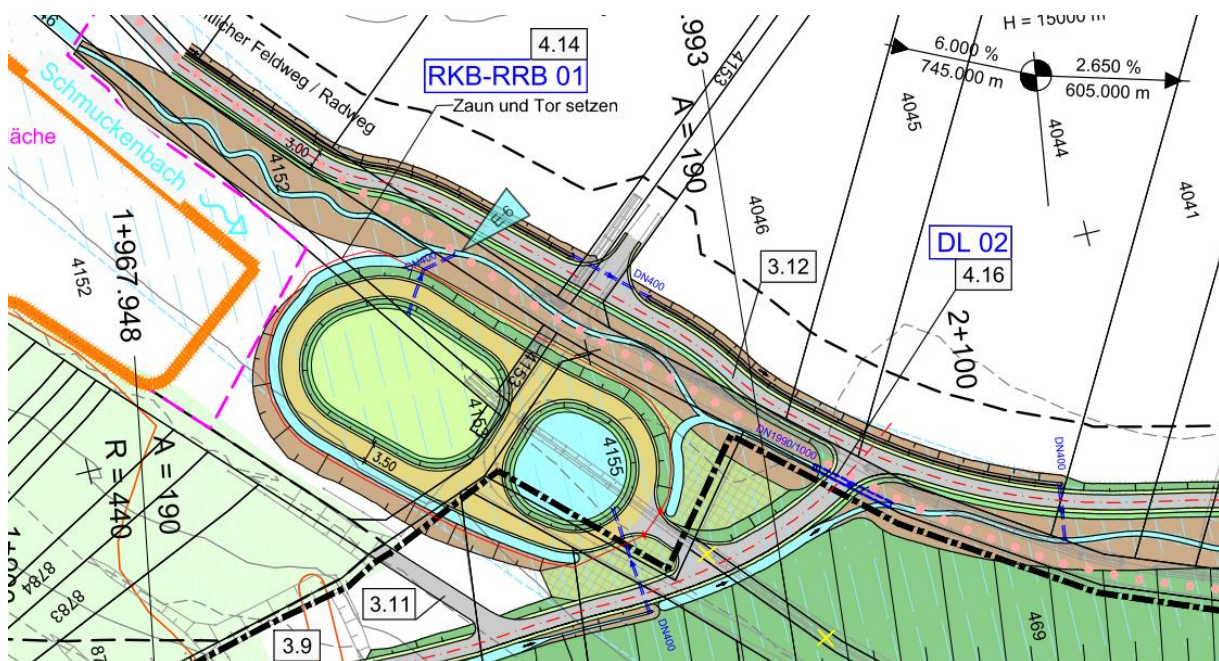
Lageplanausschnitt RKB / RRB 01
